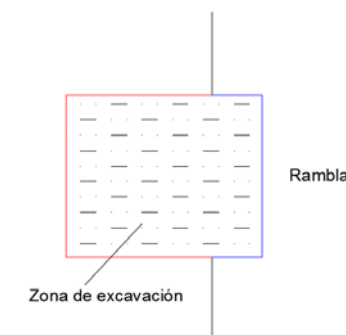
Esquema de zona de excavación y tablestacado. Elaboración propia con AutoCAD.
